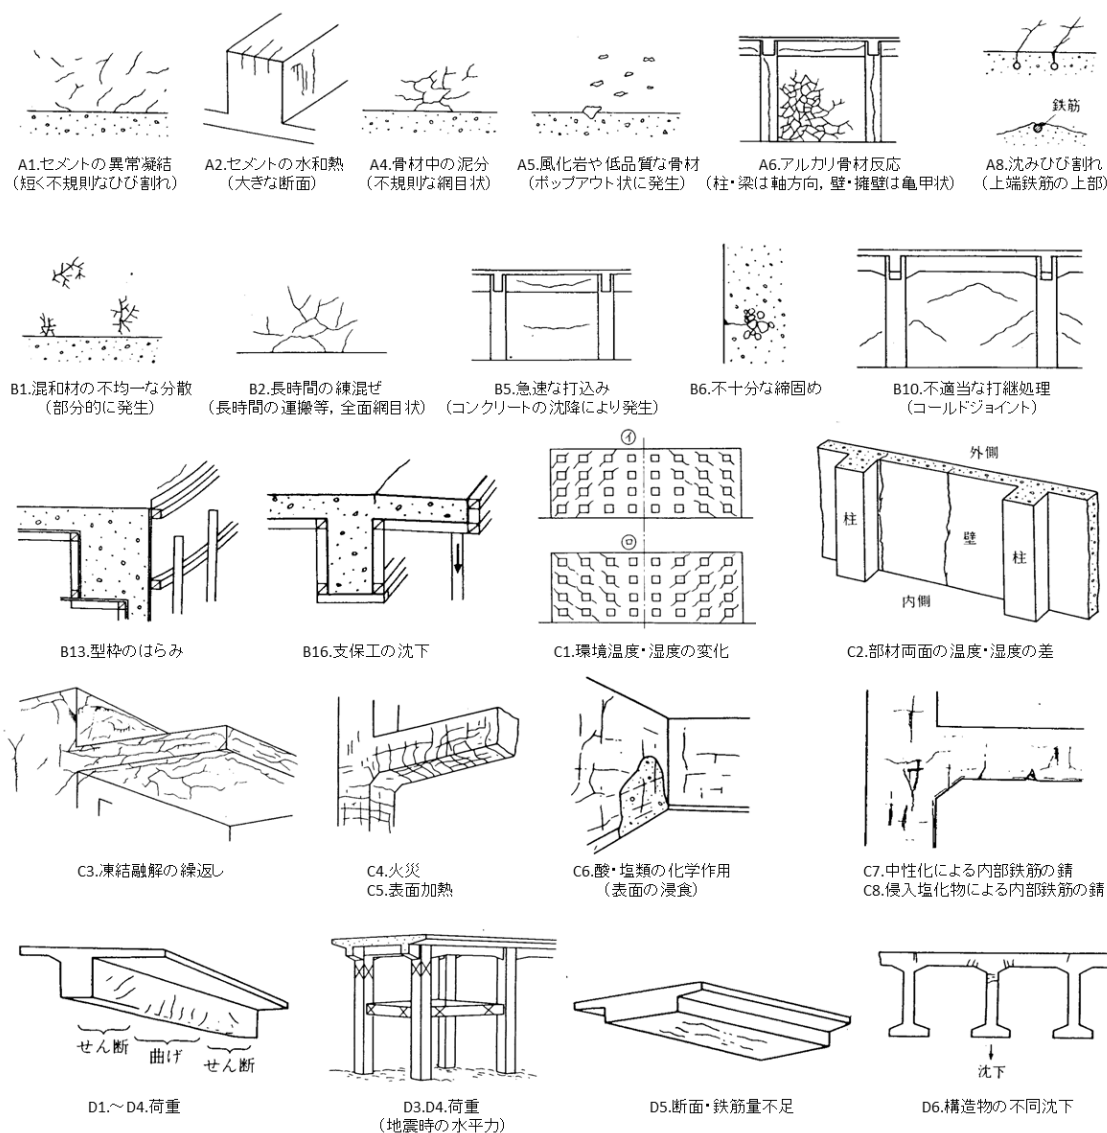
コンクリートのひび割れ例³⁾
